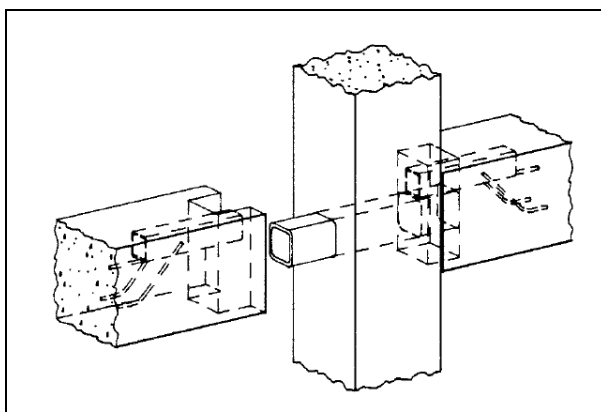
Ligação por consola curta metálica com armaduras em gancho (Sidney, 2000)
